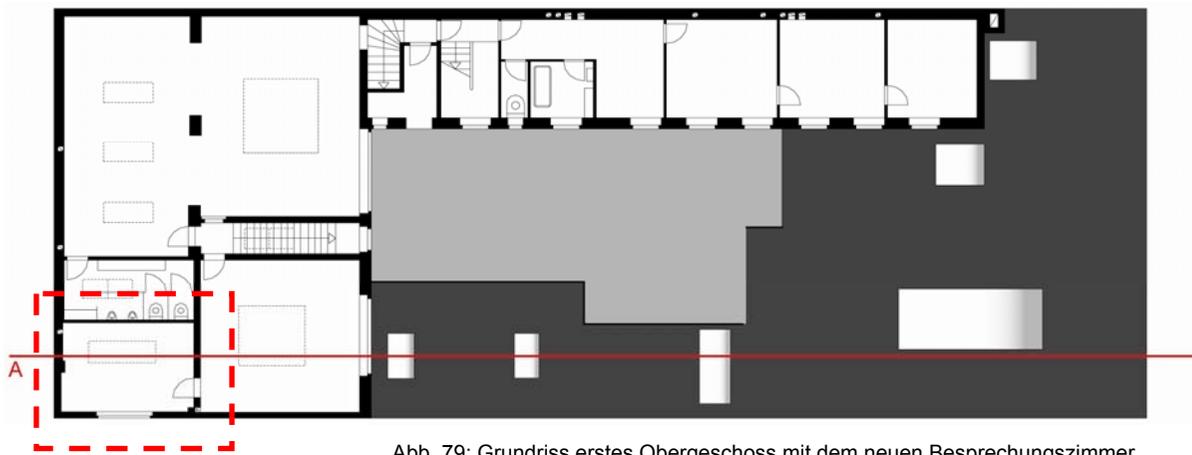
Grundriss erstes Obergeschoss mit dem neuen Besprechungszimmer
